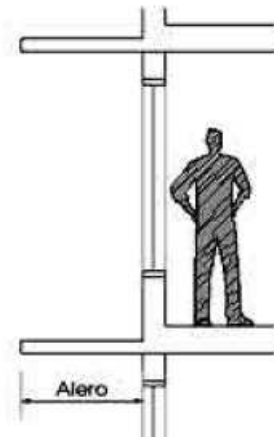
Element sortint horitzontal (alers, balco, etc)
